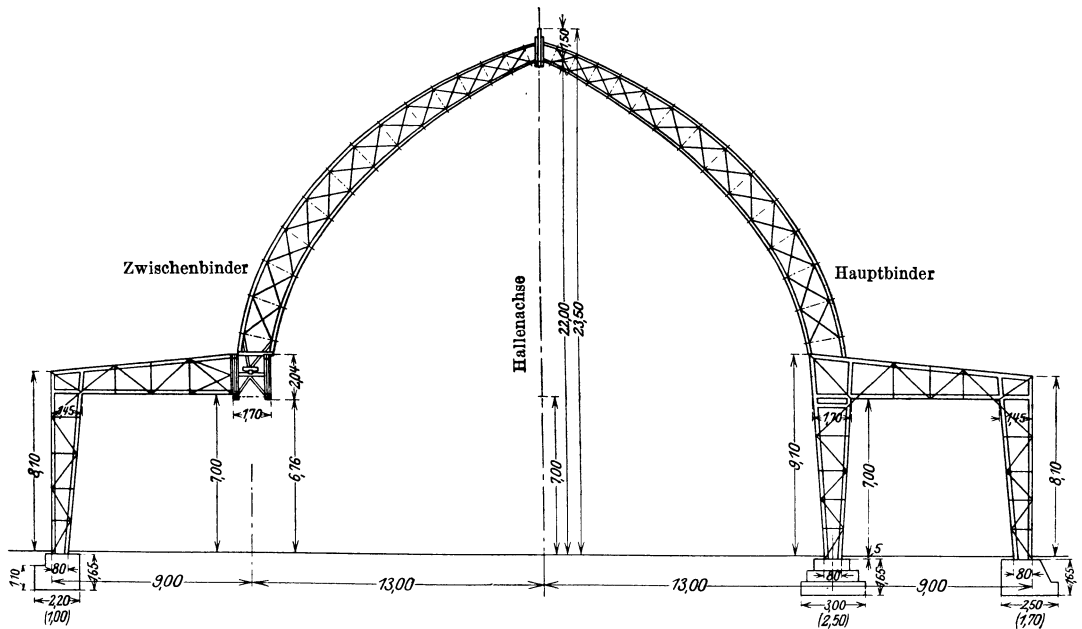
Halle für Luftfahrt auf der Deutschen Verkehrsausstellung München 1925.
